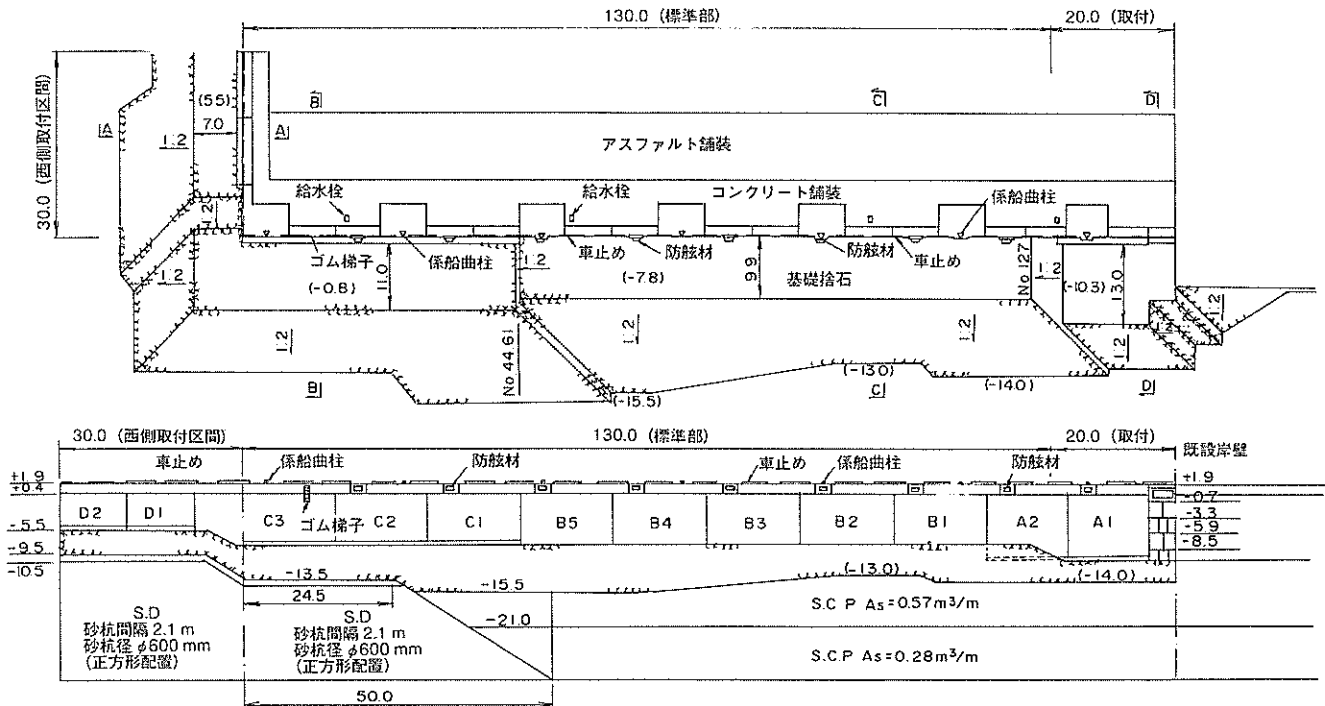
(a) 昭和南3号岸壁 (-7.5m)平面図および縦断面図
